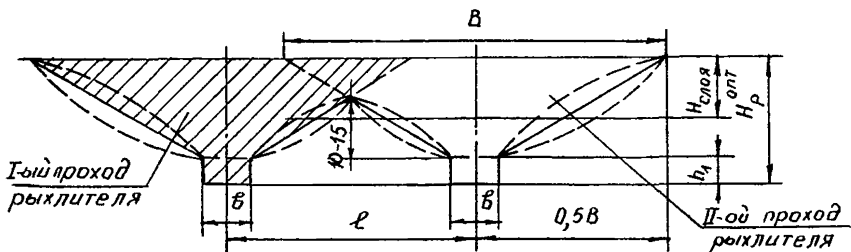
Схема поперечного сечения разрыхленного грунта
